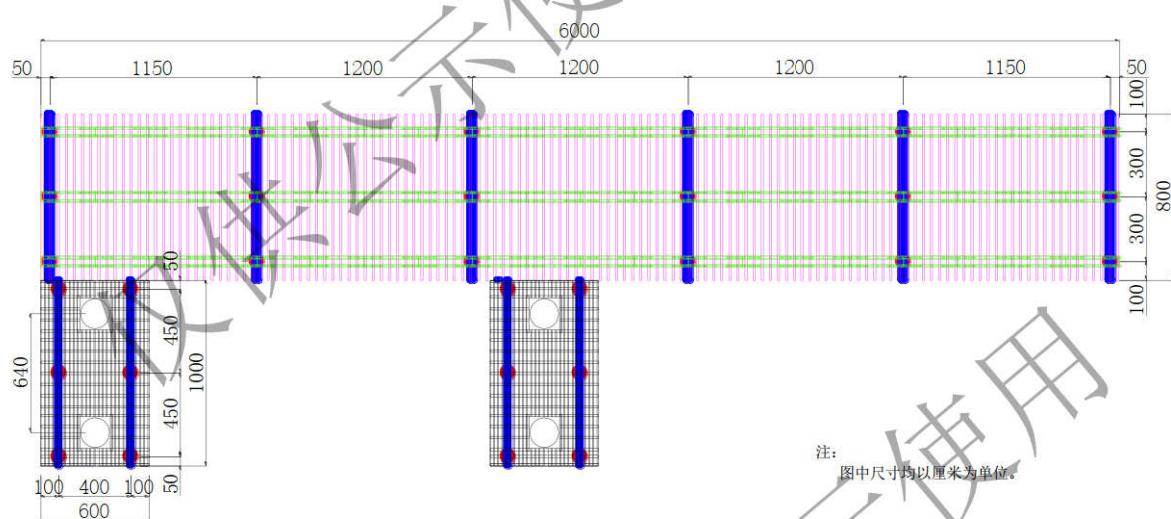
本项目钢栈桥及钻孔平台平面布置图
